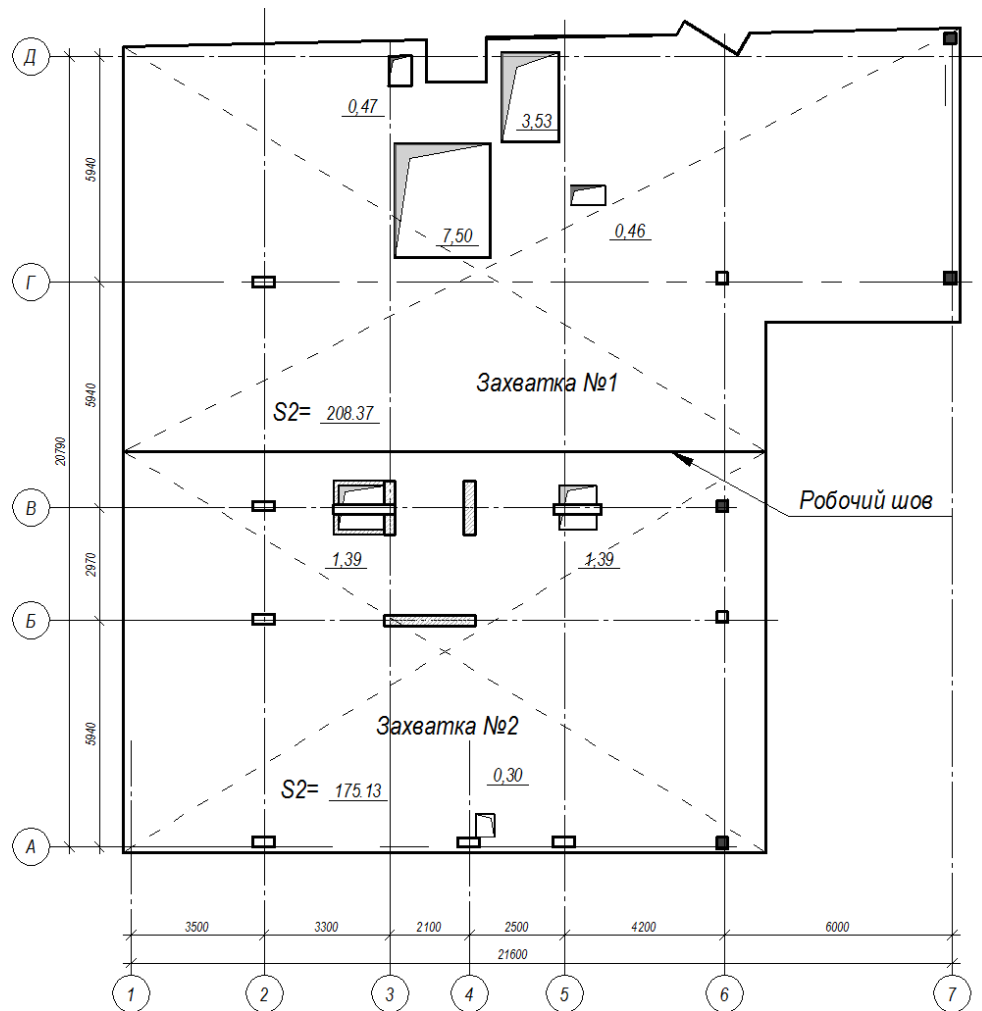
Схема розбиття плити перекриття на захватки
